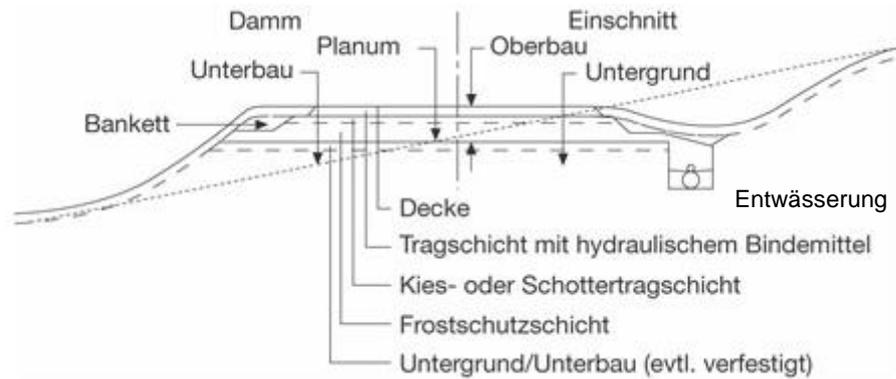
Beispiel für Straßenaufbau mit wasserdurchlässigen Randbereichen – Damm/Einschnitt (Quelle: U 42)
